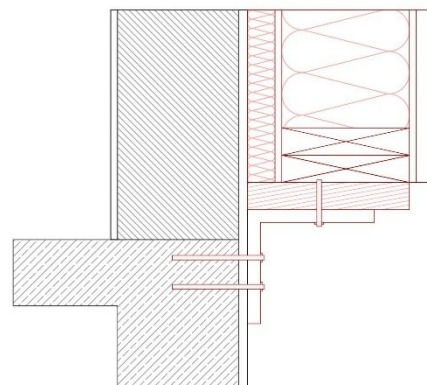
Stahlwinkel in Geschossdecke mit Auflagerung oben
